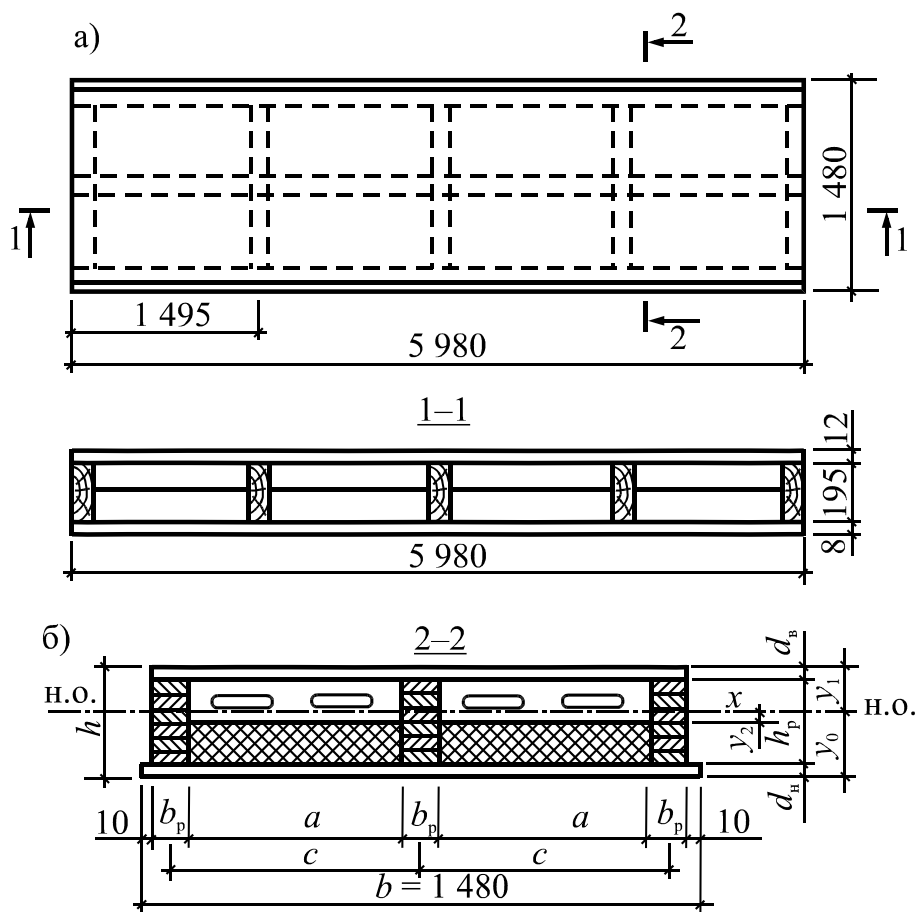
План (а) и разрезы (б) клеефанерной плиты покрытия под рулонную кровлю
